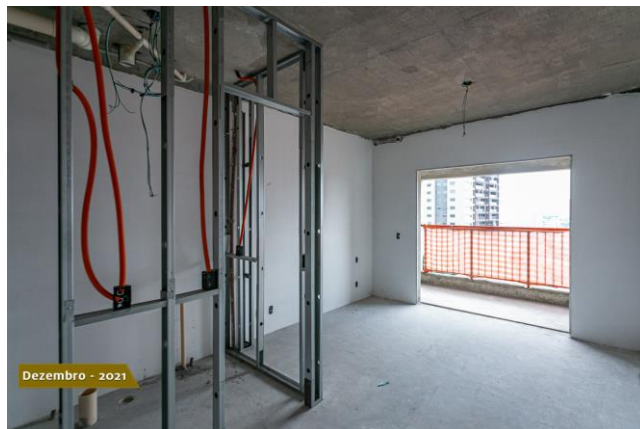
Alvenaria com acabamento e estrutura de dry wall.
